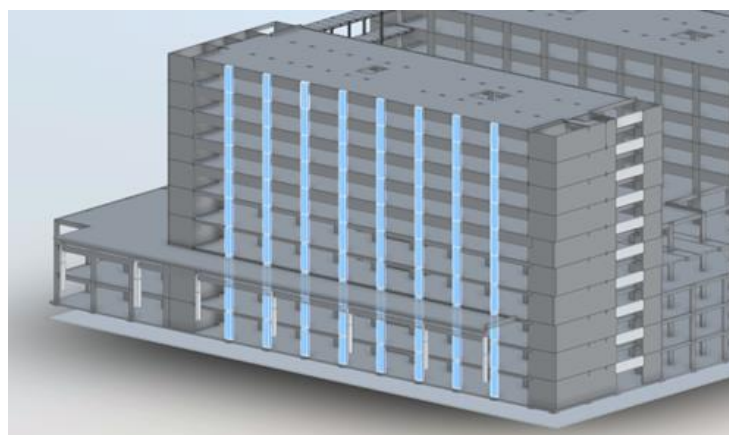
Ilustração dos pilares das fachadas com secção aumentada, 0,40x1,30 m² (ARSLVT, 2026)
